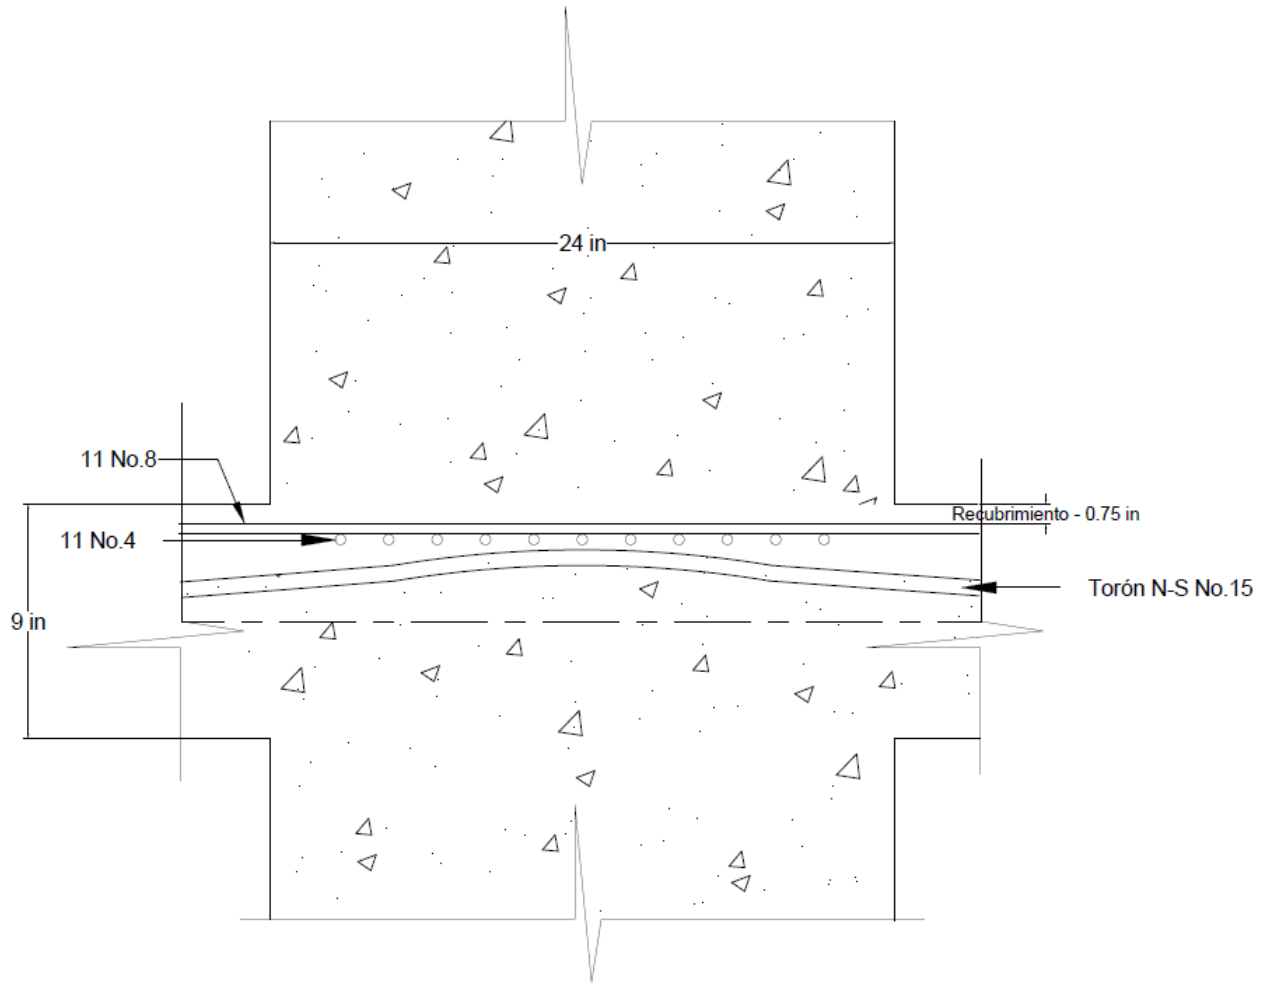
Detalle arreglo de refuerzo y torones en columnas
